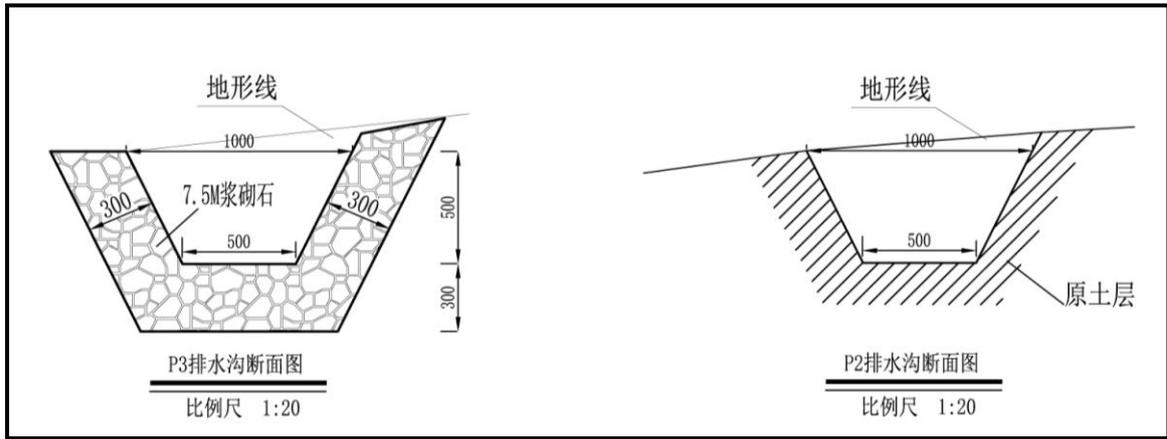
P1、P2 排水沟断面图（单位：mm）
